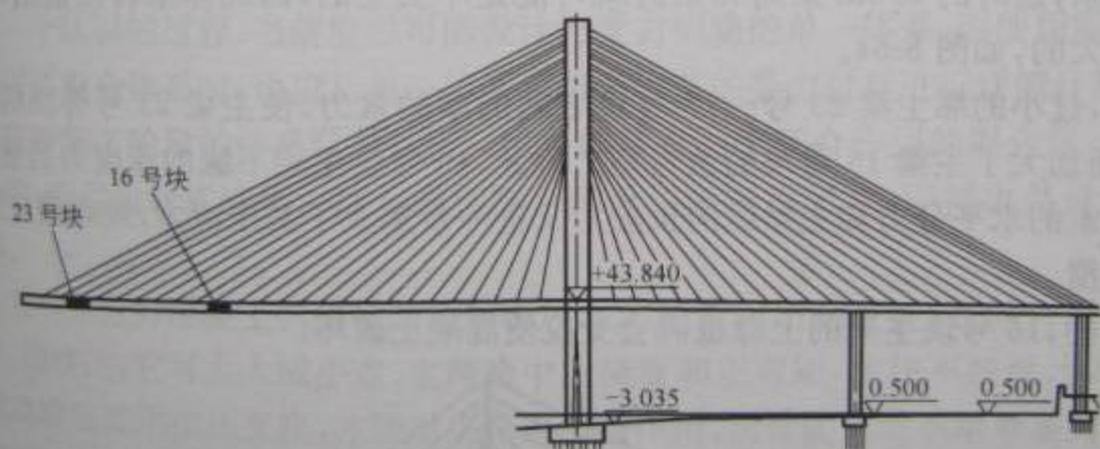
辅助墩与 16 号块的关系图(尺寸单位:m)
